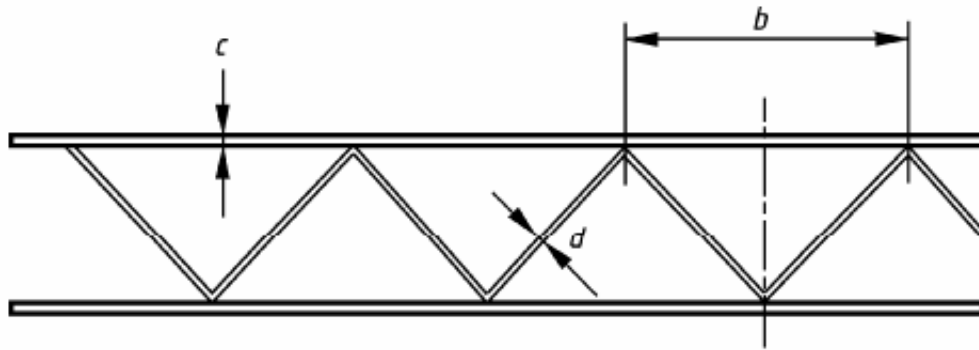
Пример арматуры фахверкового типа – вид сверху
